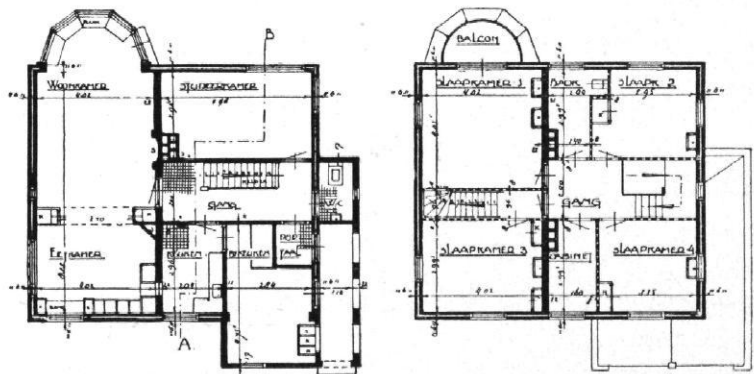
und 7 / Grundrisse 1:250 zu Abbildung 8
